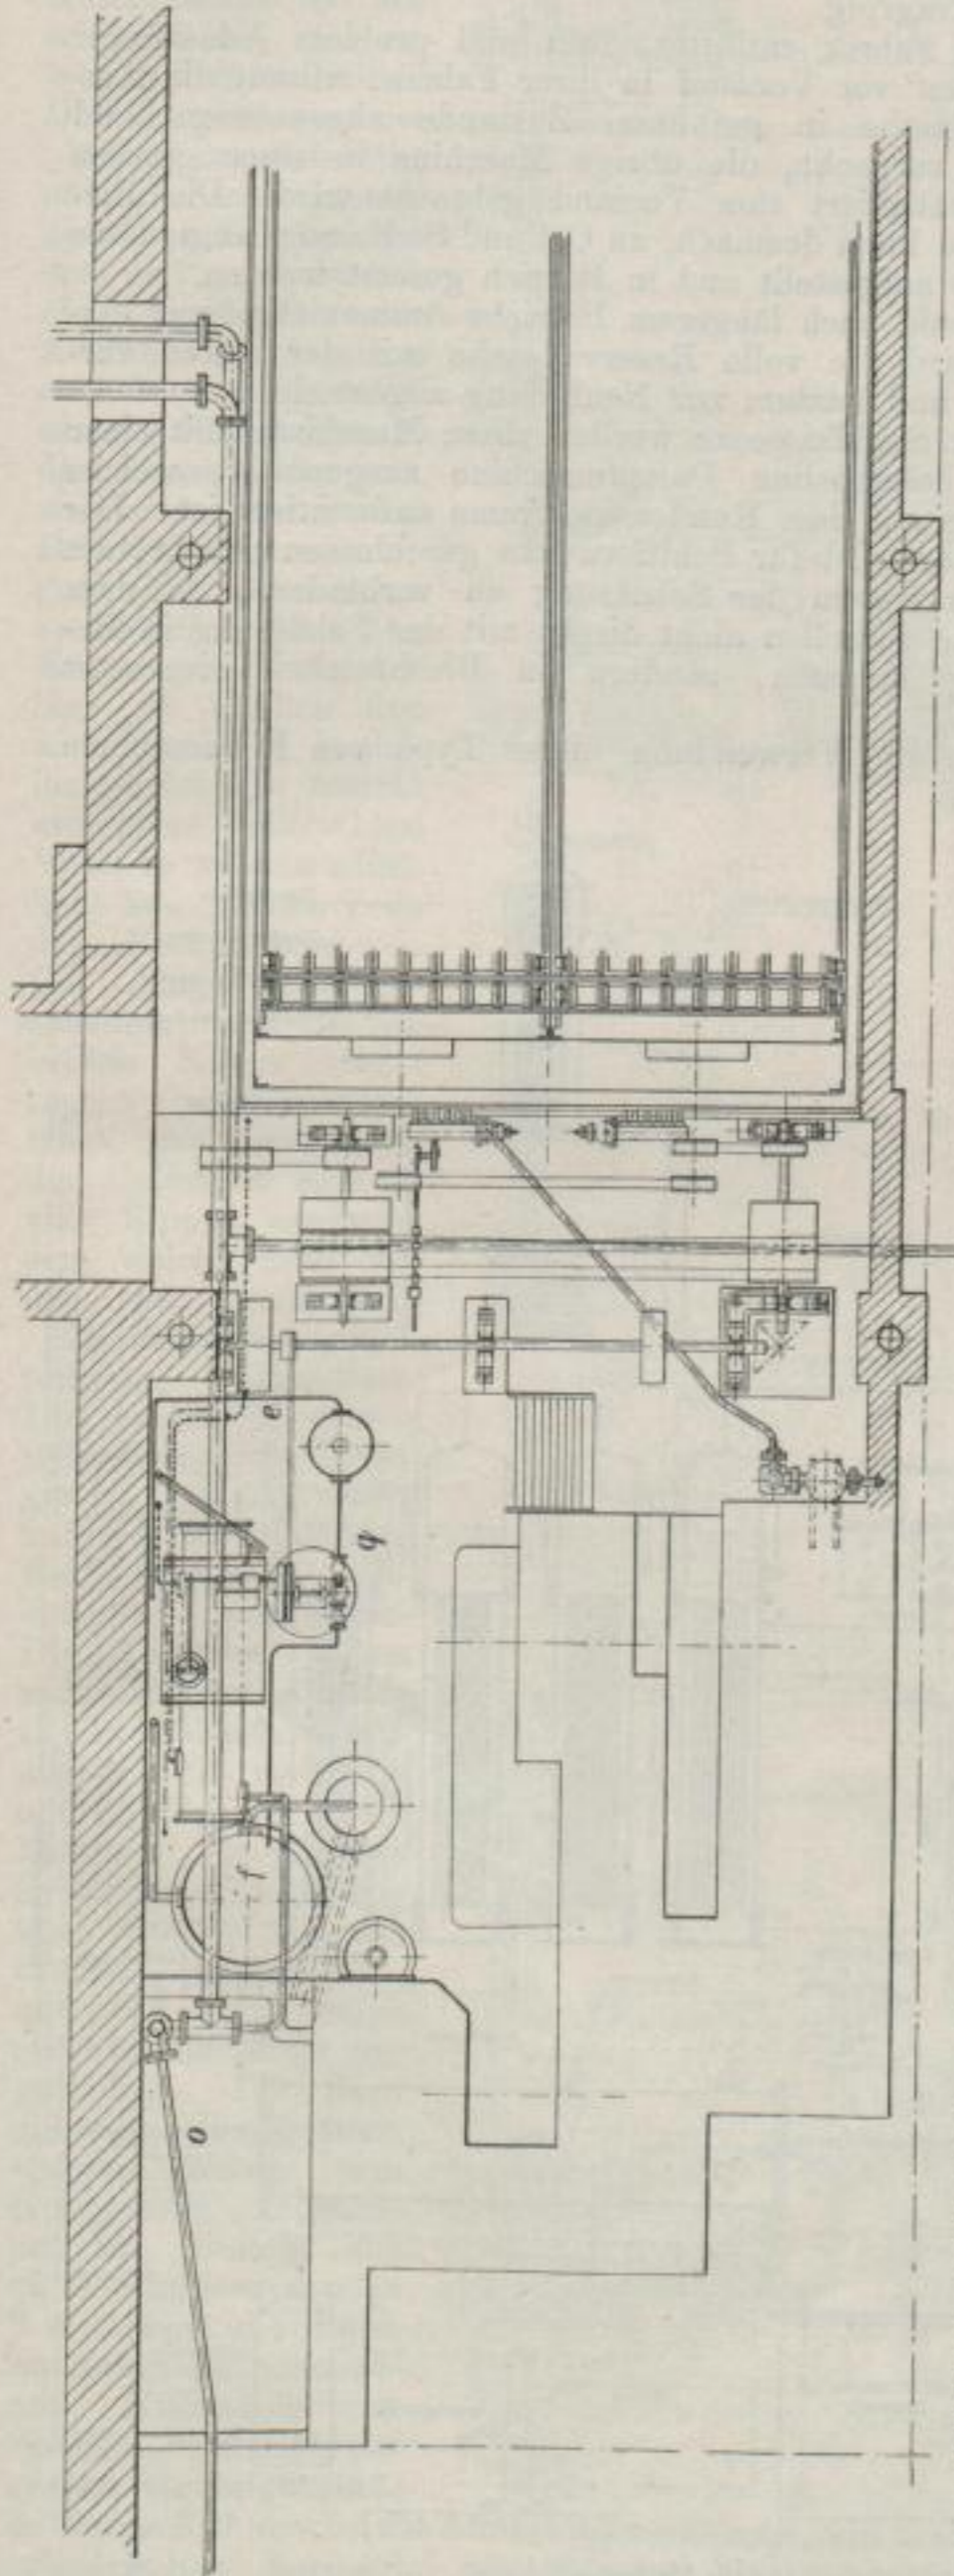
Grundriss des Souterrains. (Schnitt C D.)
